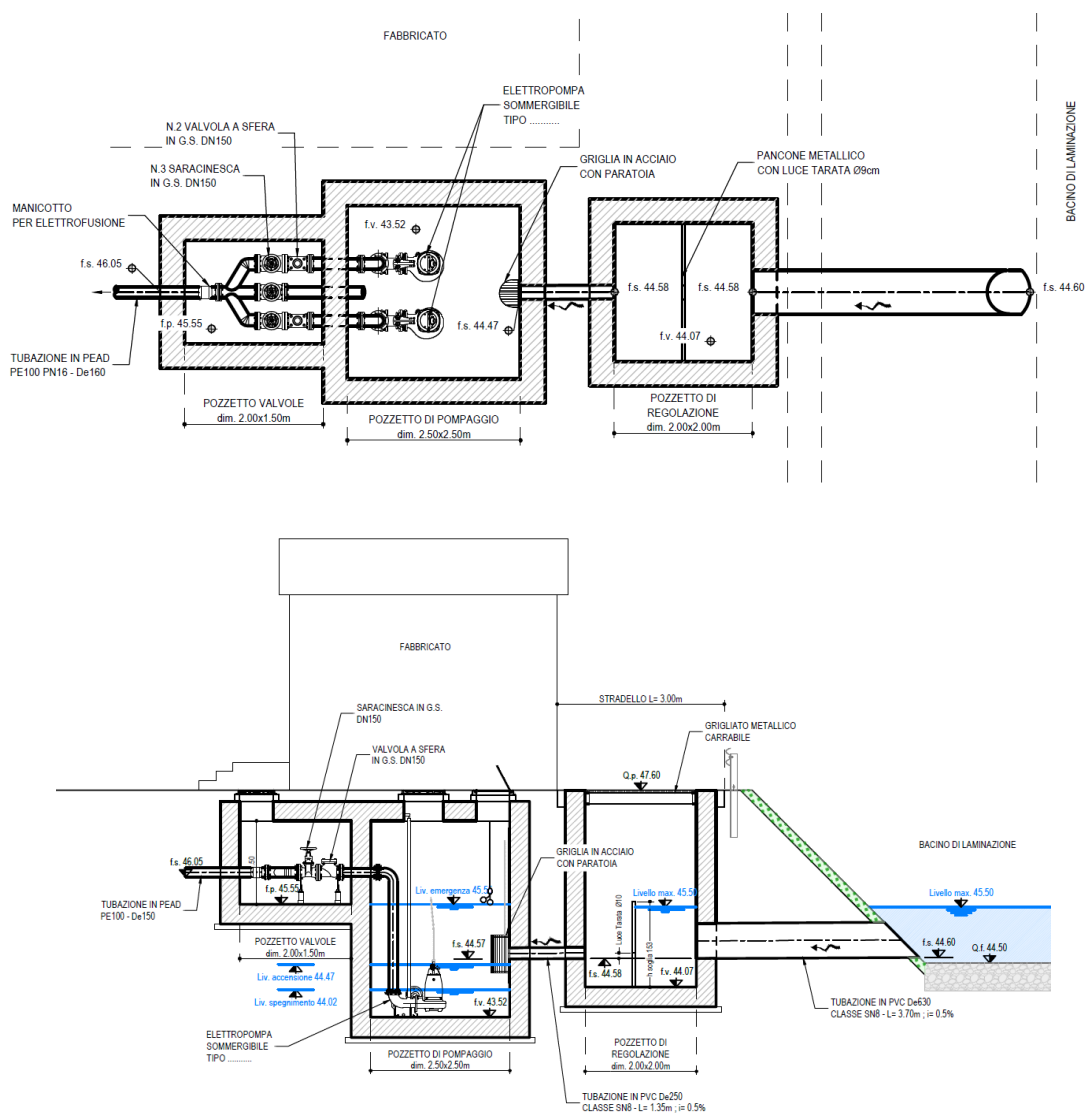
Pozzetto di regolazione, pozzetto pompe e pozzetto valvole - Pianta e sezione
